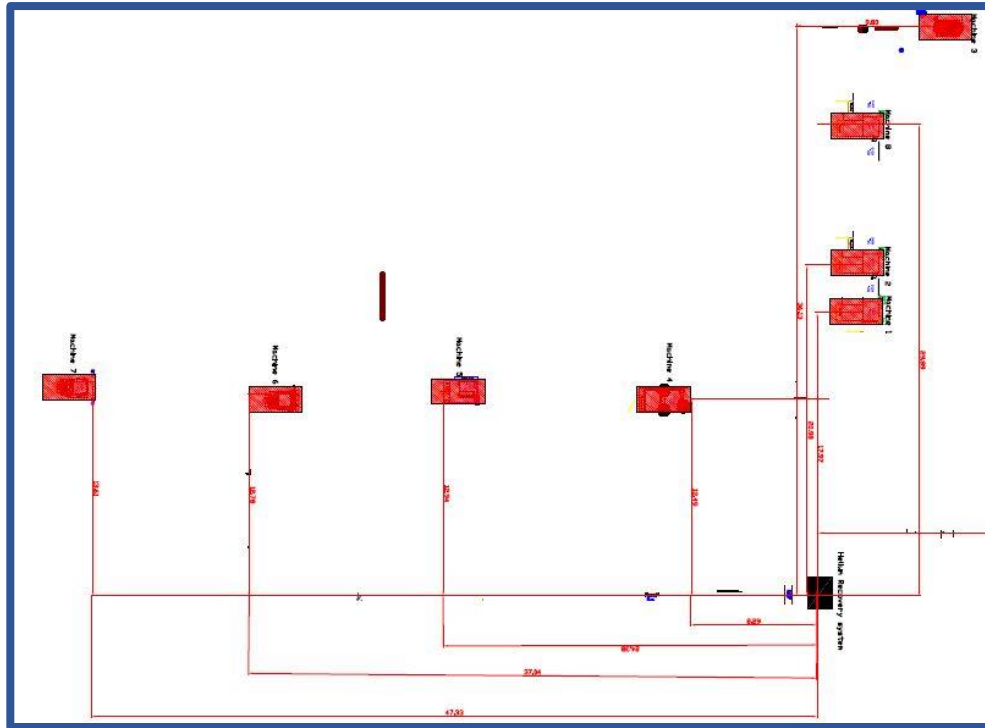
Layout con dimensiones de las máquinas de prueba
